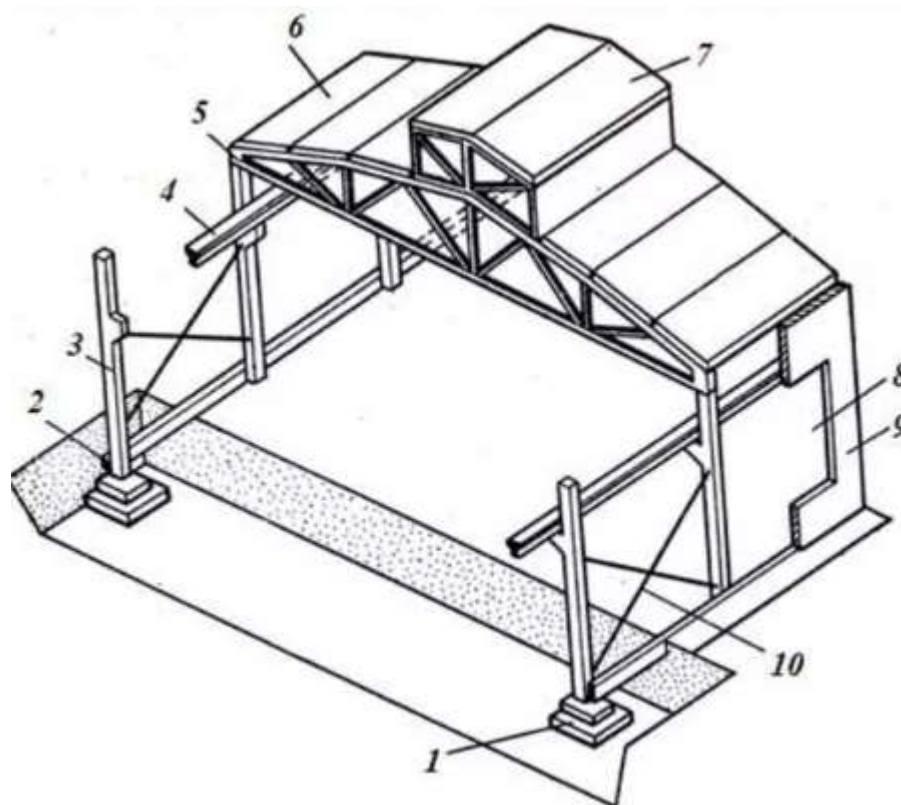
Основні конструктивні елементи каркасу одноповерхової промислової будівлі: 1 – стовпчасті фундаменти; 2 – фундаментні балки; 3 – колони; 4 – підкранові балки; 5 – ферми; 6 – плити покриття; 7 – ліхтар; 8 – вікна; 9 – стіна; 10 – зв'язки
